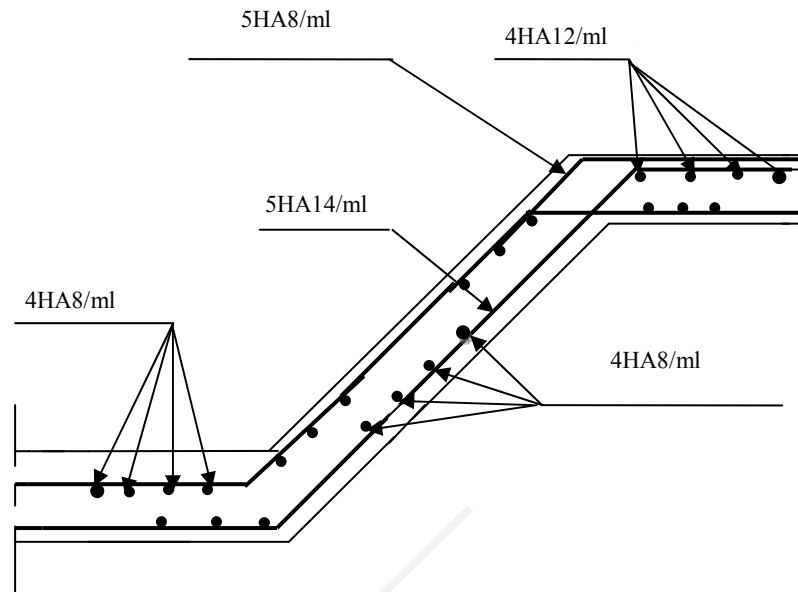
schéma de ferrailage des volées de l'escalier du type 01
